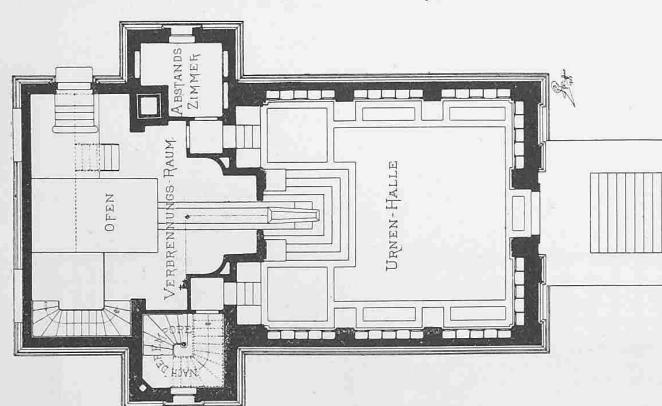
Grundriss vom Erdgeschoss. — Masstab 1:250.
